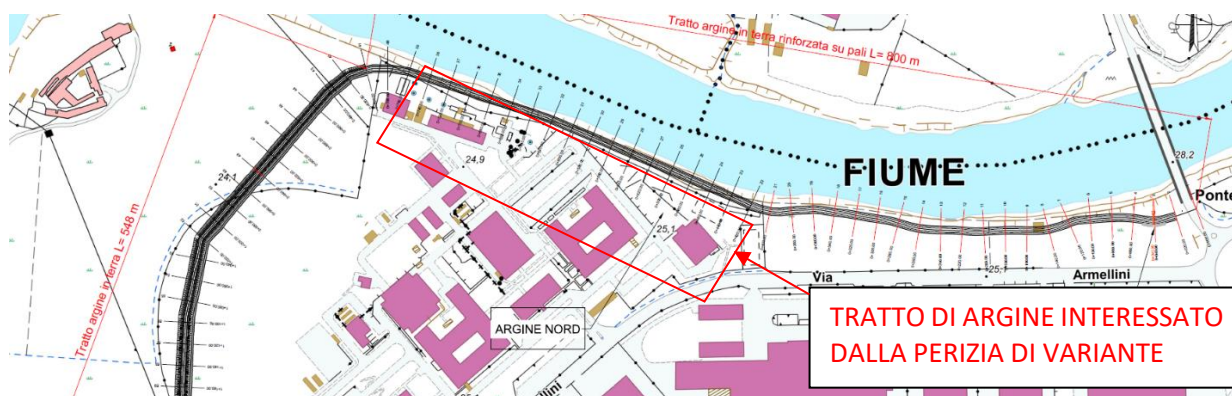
Estratto planimetrico di progetto con individuazione del tratto interessato dalla perizia di variante (da sez.20bis a sez.39)
